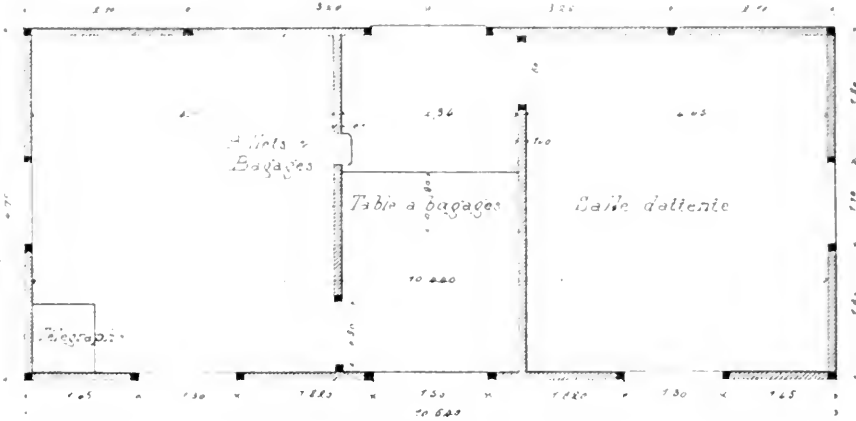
Plan Coupe cd a 0 001 p^r1^m
